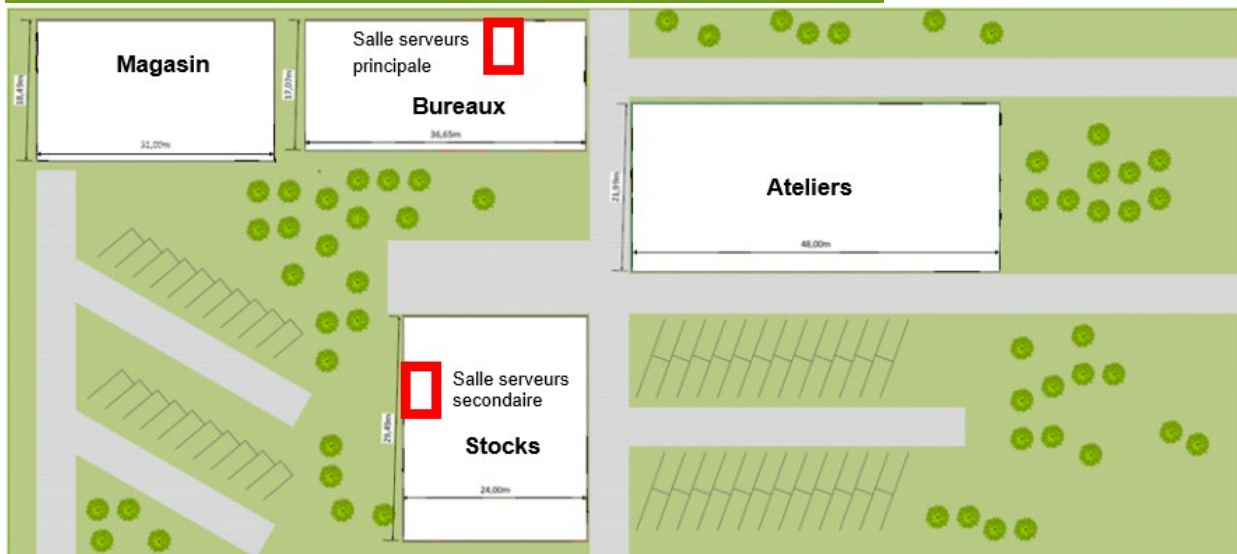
Plan d'implantation des serveurs à Anancy 1/2
